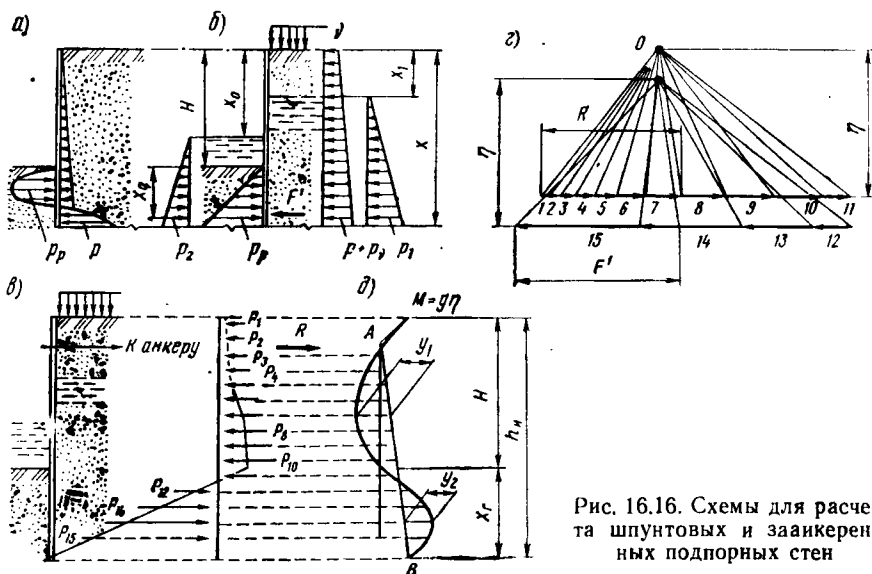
Схемы для расчета шпунтовых и заанкеренных подпорных стен
